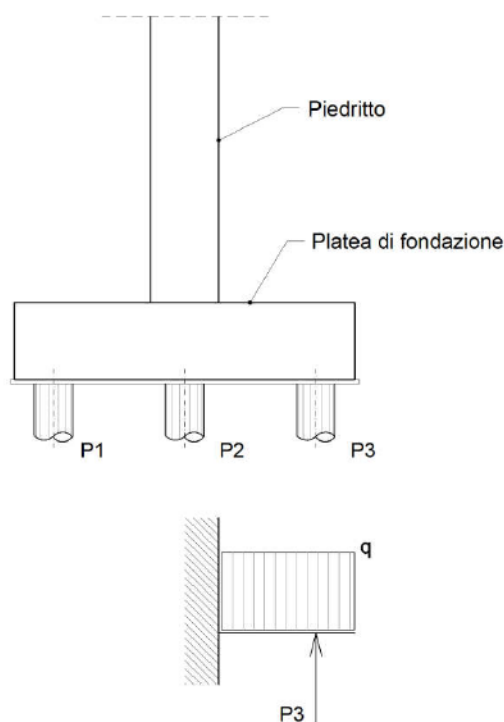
Schema di calcolo sezione longitudinale spalla
